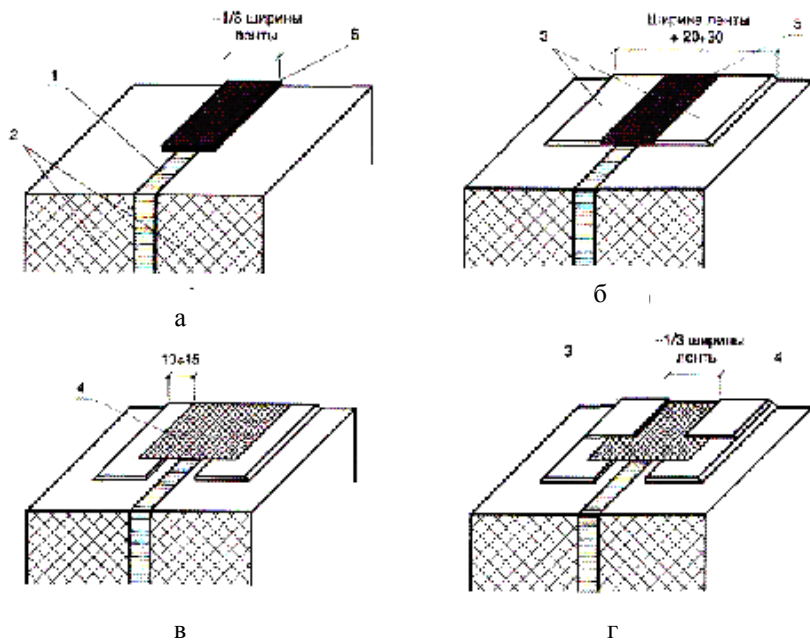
Монтаж эластичной гидроизоляционной ленты на бетон при ее креплении цементно-полимерным составом:
